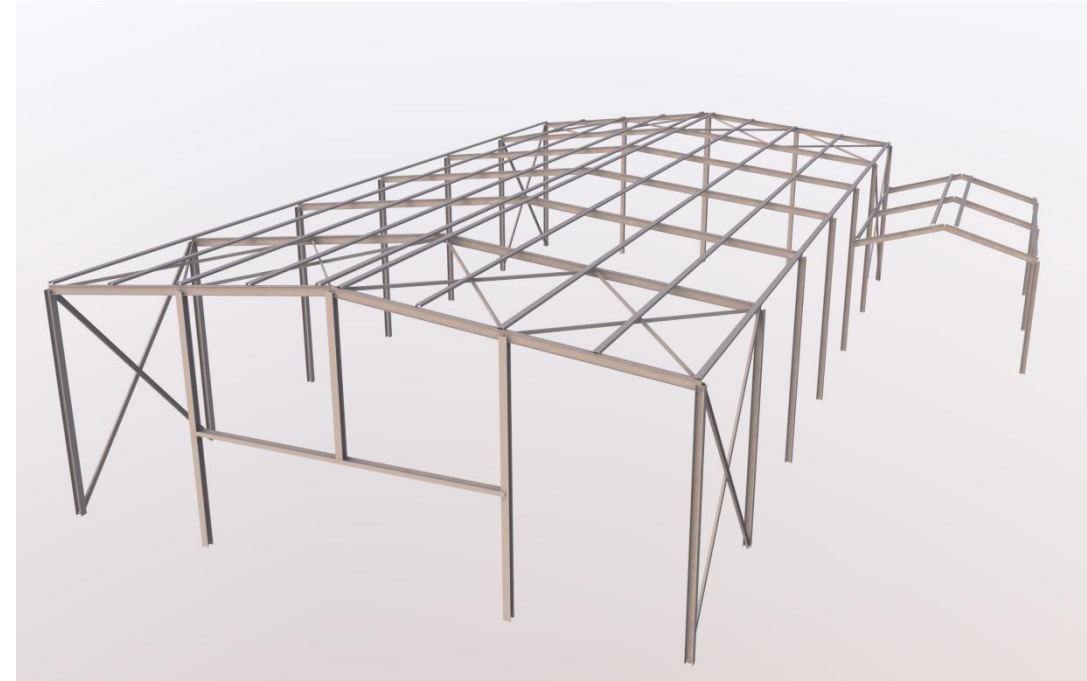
Modelo estructural de la solución de cubierta metálica a dos aguas. Vista 1
